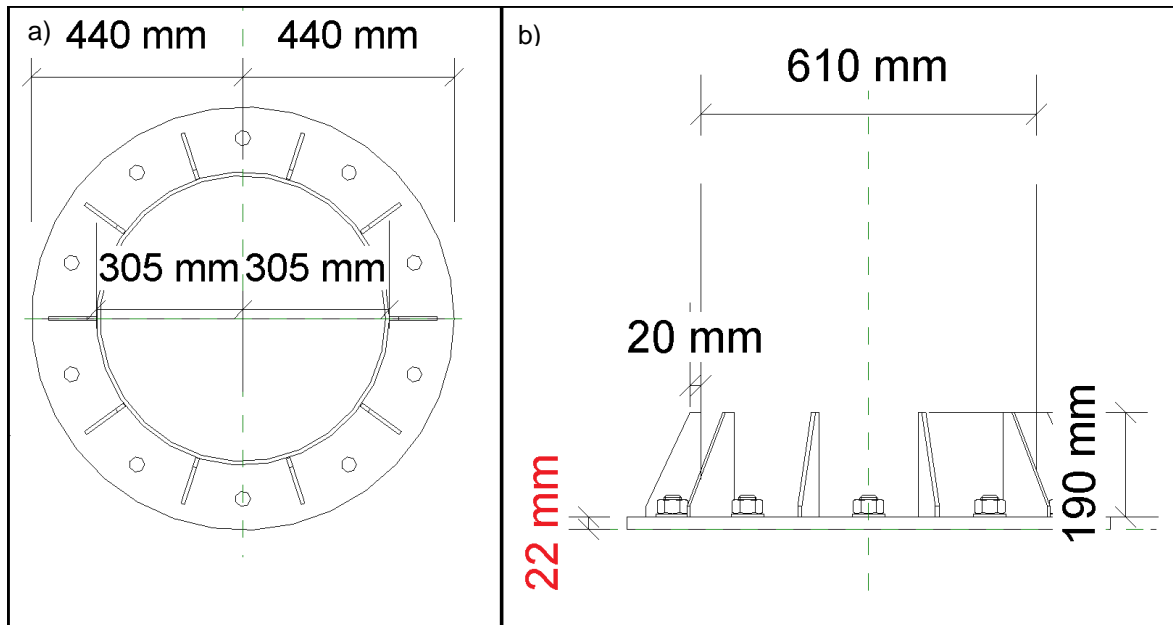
a) Corte; b) alçado: base do Pilar P1
